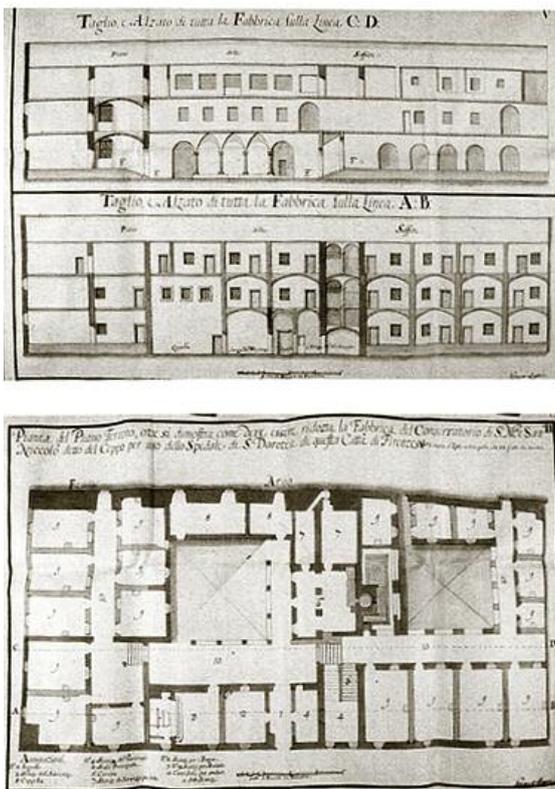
Spedale di Santa Dorotea, Planimetria del piano terra e sezione, 1753.
